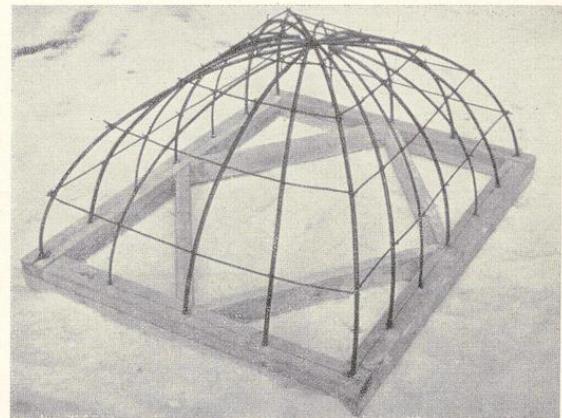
Kloster gewölbe über quadratischem Grundriss
